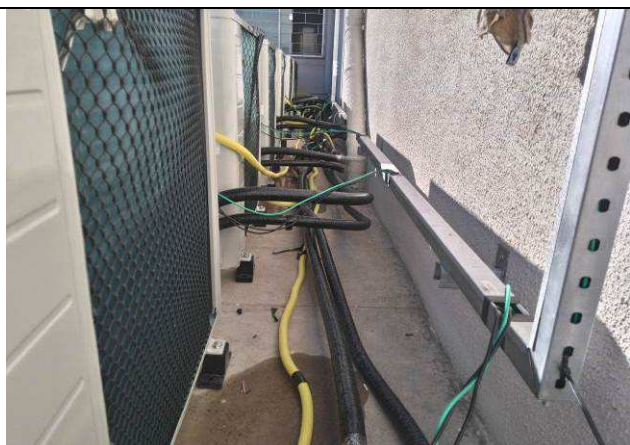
E: Infraestrutura perfilados - alimentação condensadoras 1º pavimento.
